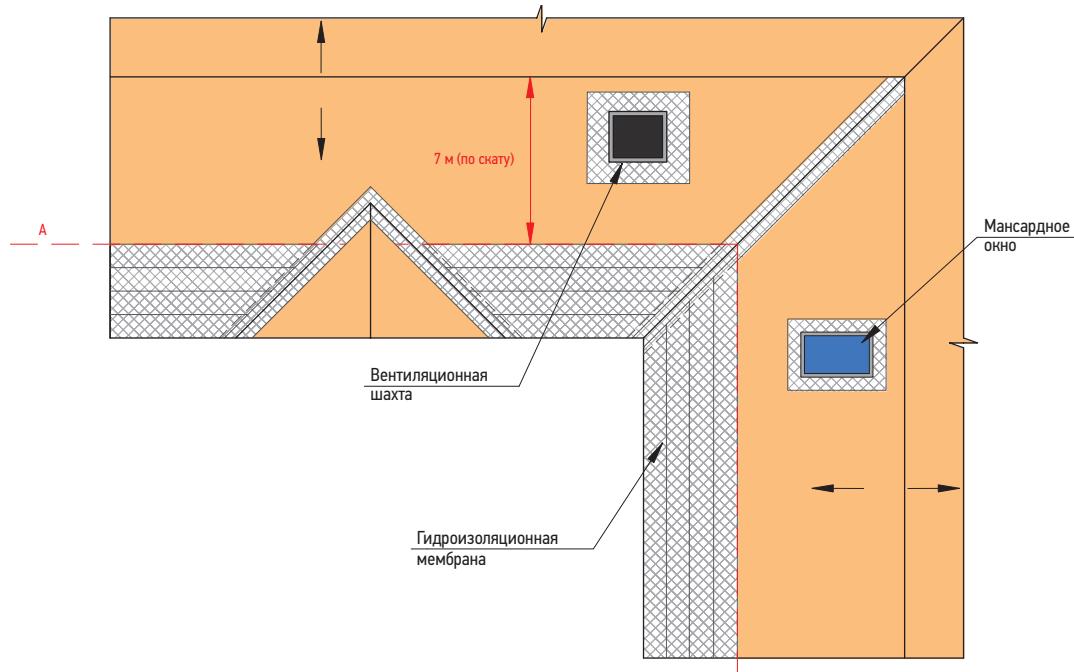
Частичный с дополнительными рядами гидроизоляции по карнизу крыши
